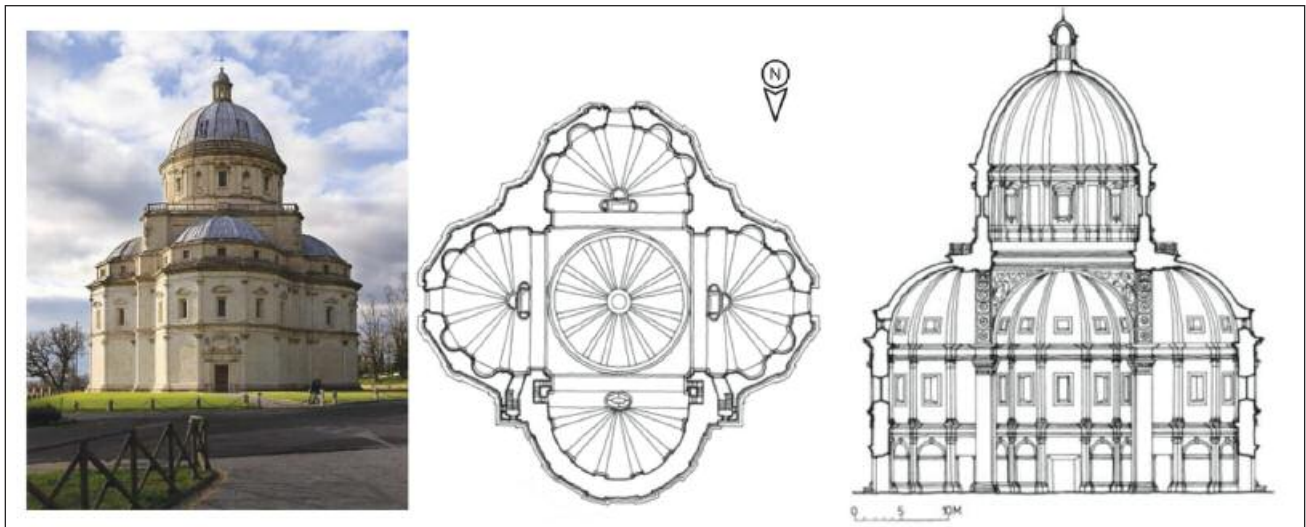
La chiesa di Santa Maria della Consolazione a Todi, immagine esterna (foto degli autori); pianta e sezione verticale (da "Sir Banister Fletcher's Global History of Architecture", 1896).
